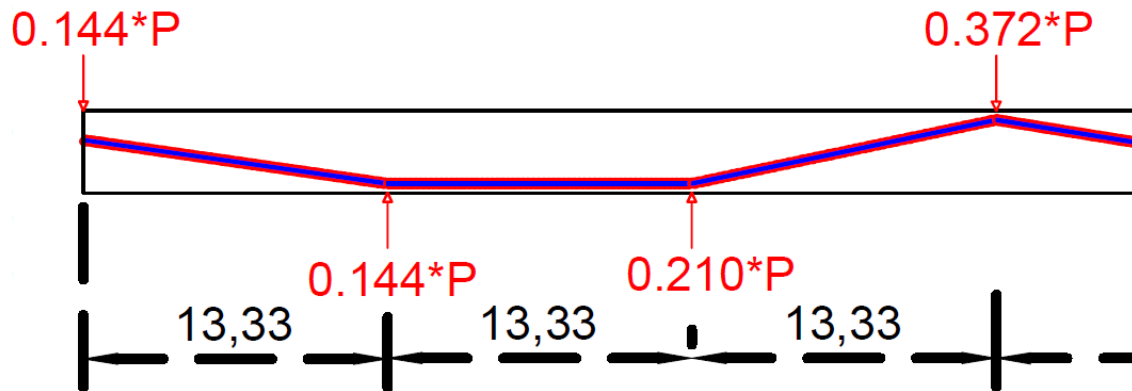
Traçado dos cabos de pré-esforço no primeiro vão.
